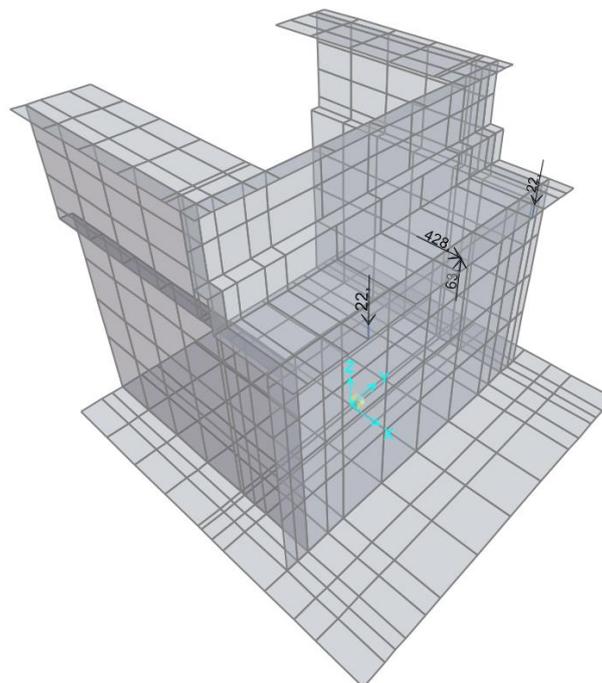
Modello FEM Finale – Vista assometrica carichi da frenamento da impalcato kN su spalla fissa (imp_fren)
